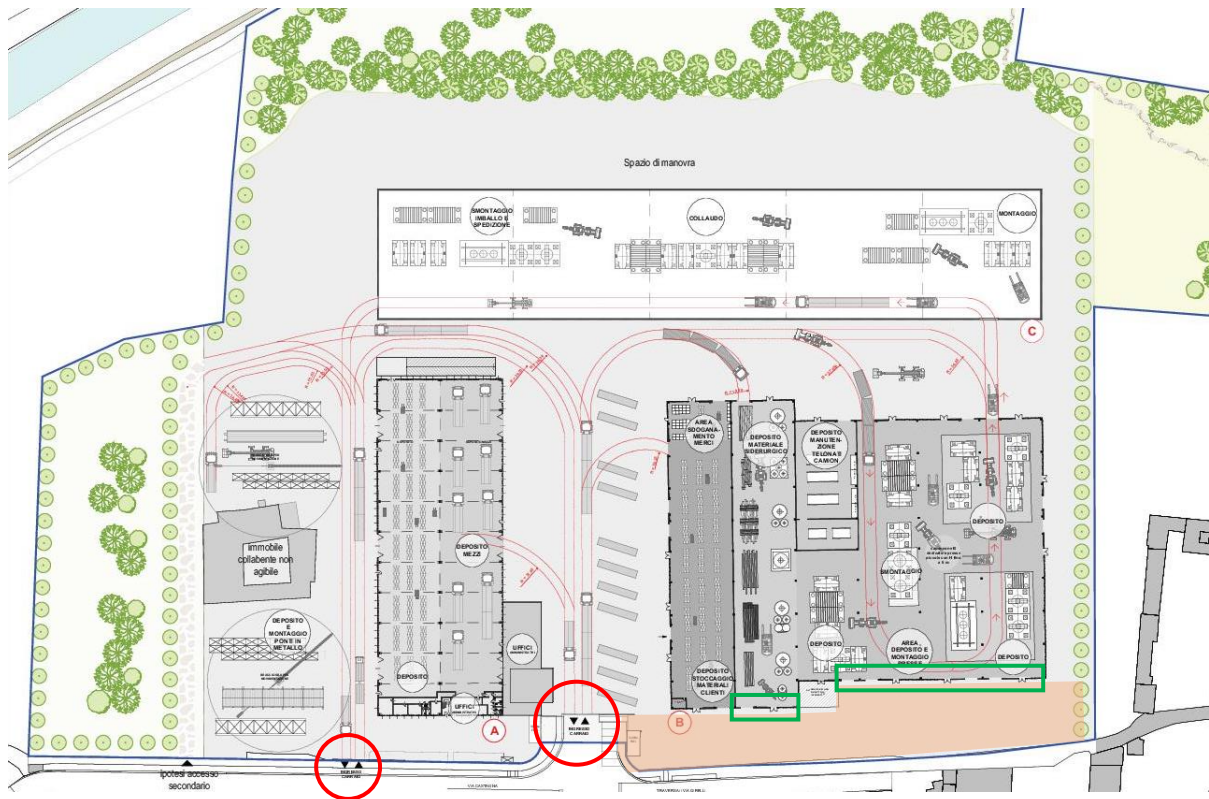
Planimetria di progetto e indicazione delle misure di mitigazione
